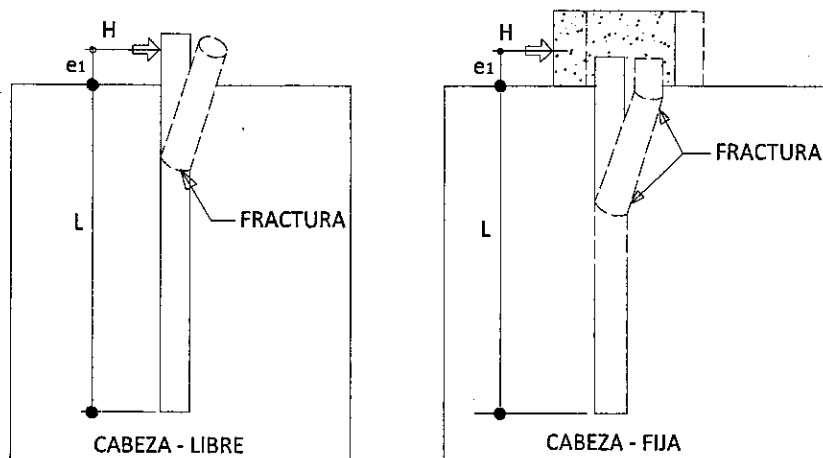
Pilote vertical largo bajo carga horizontal (GEO, 2006)
